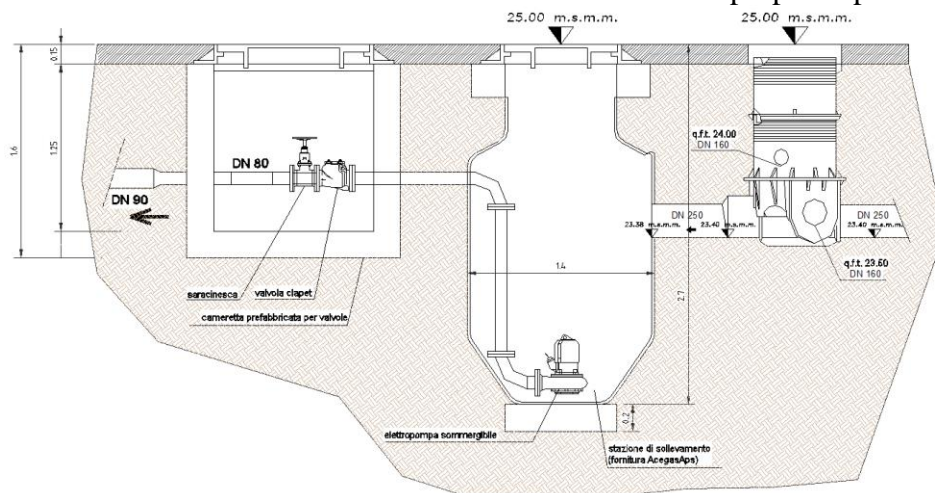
Stazione di sollevamento fornita dalla Stazione Appaltante: schema tipo
